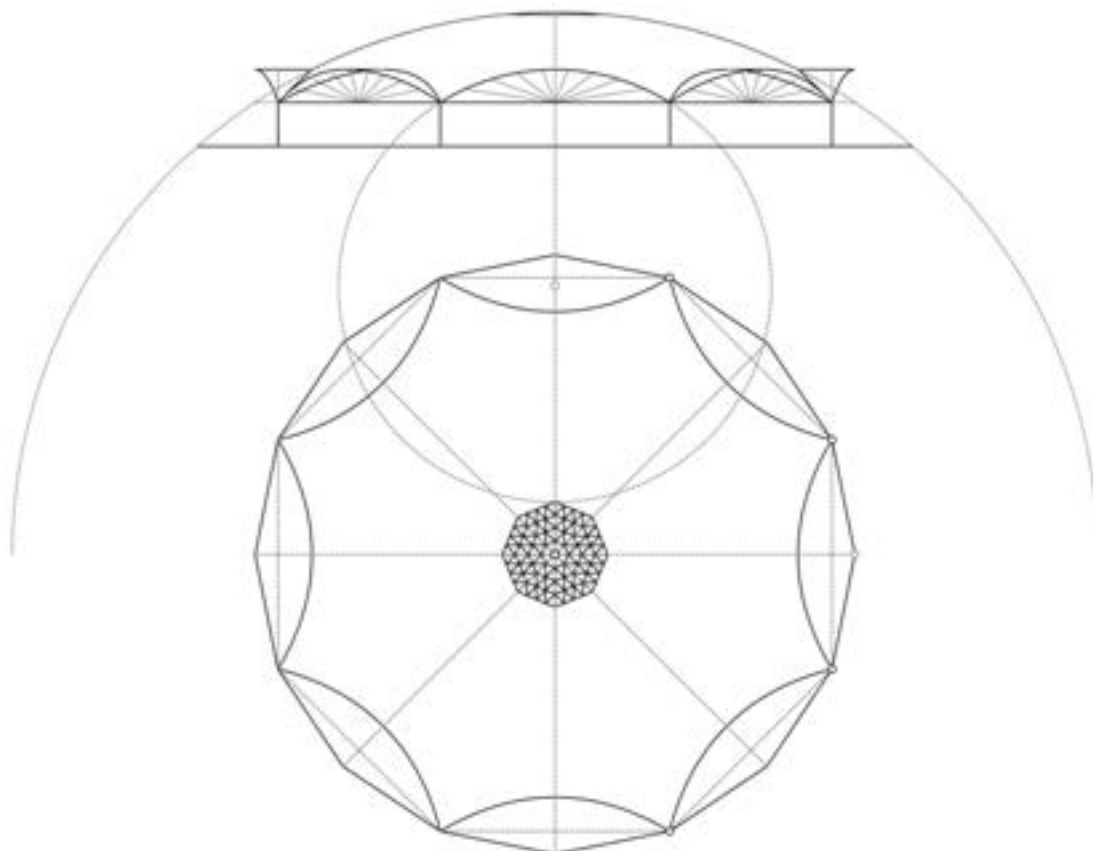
Esquema planta y alzado del Mercado de Algeciras, Eduardo Torroja, 1935. Dibujo de los autores.
